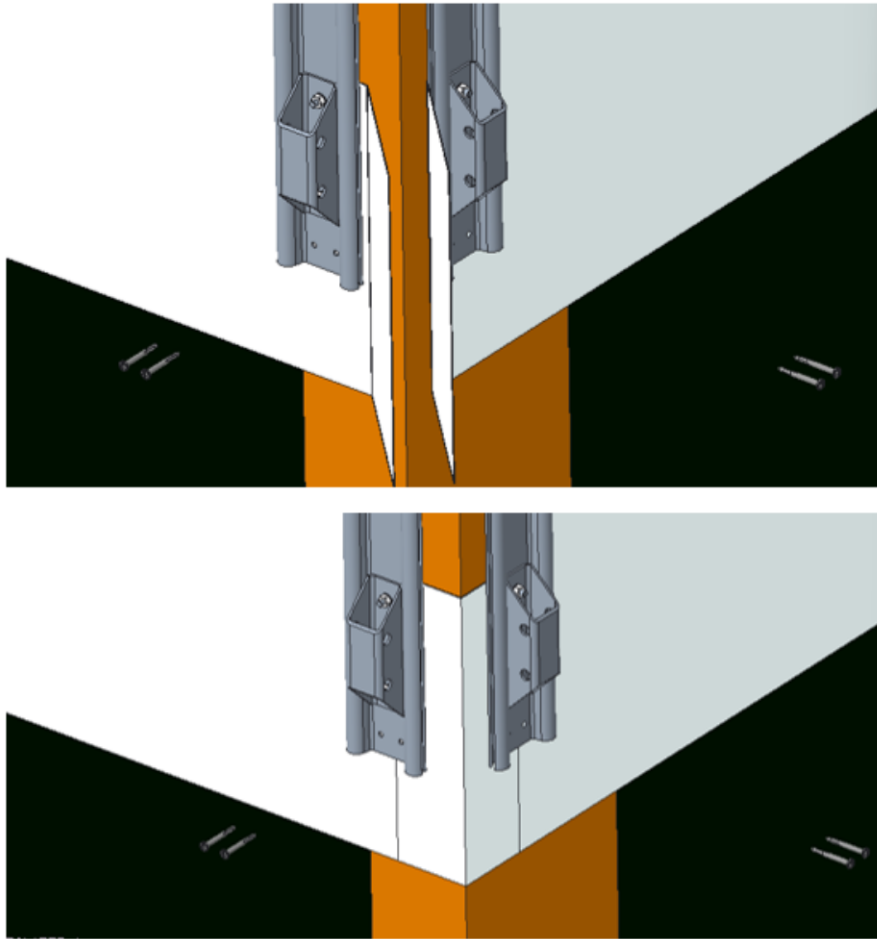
Complément d'étanchéité en partie basse des membranes de façade
